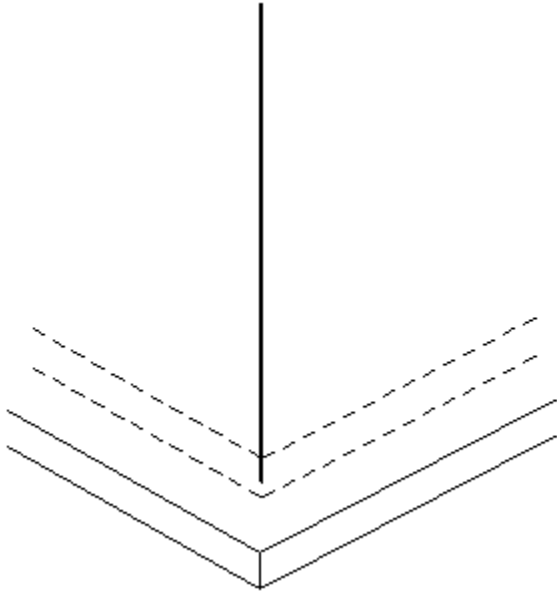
En el cemento (platea, viga de encadenado, etc) se prevé dejar el hierro de anclaje.
